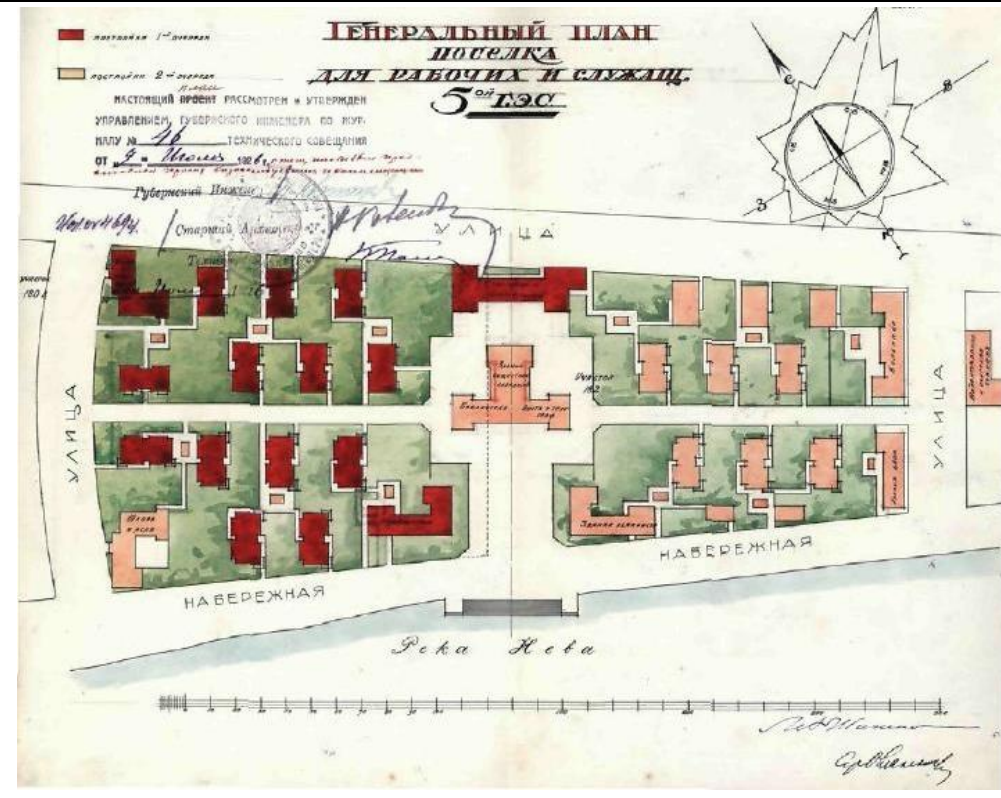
Проектный генеральный план (в полной мере не реализован)
